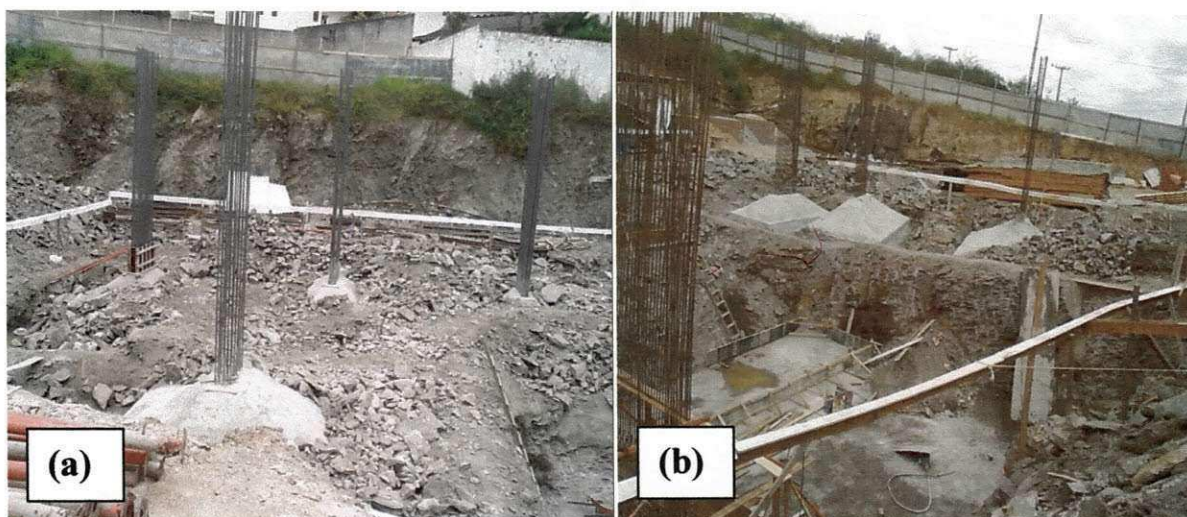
Fotos mostrando sapatas concretadas (a) e (b)
